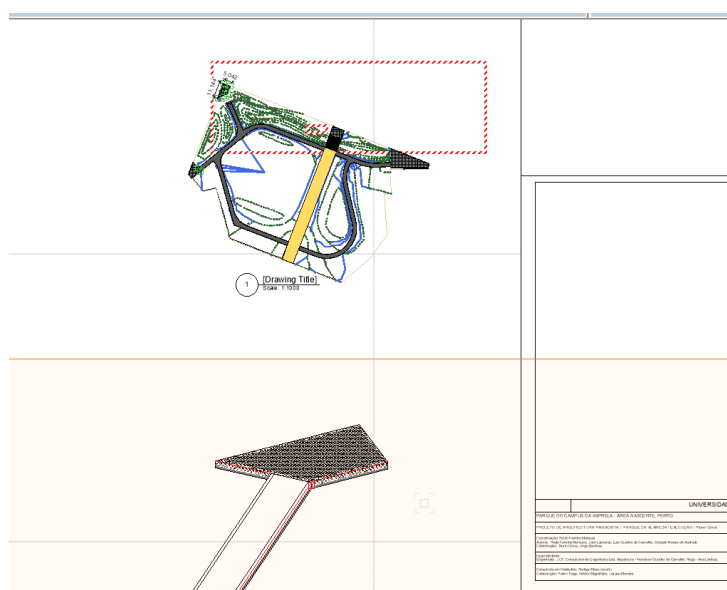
Peça técnica - Plano com pormenor construção em 3D – Estilo diferente
